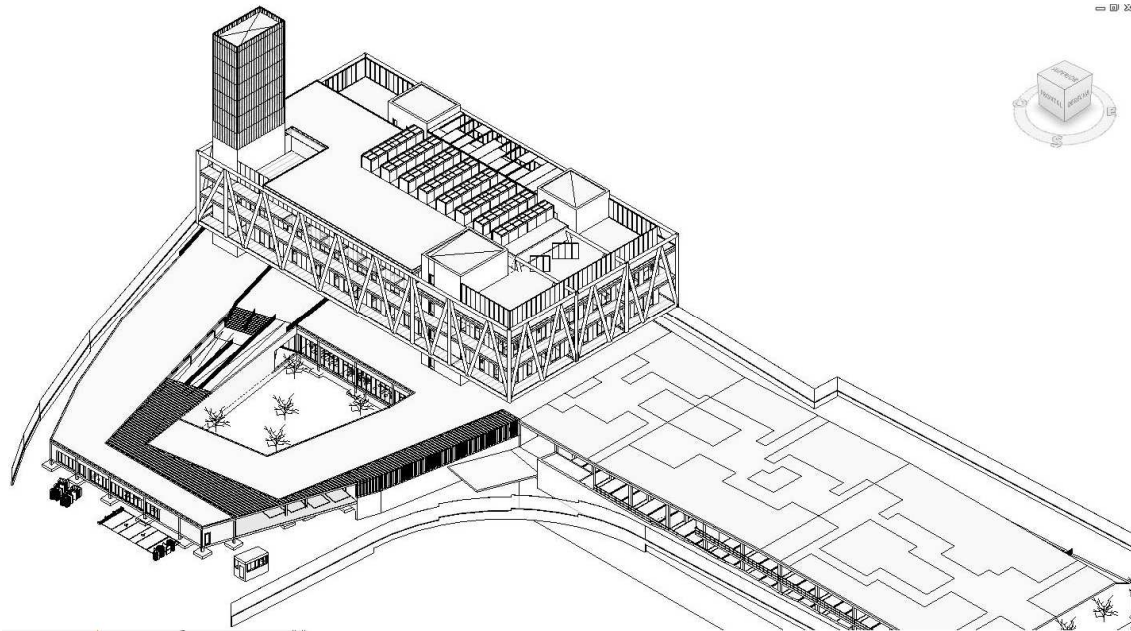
Vista general del modelo realizado. (Imagen propia del Revit Architecture)
